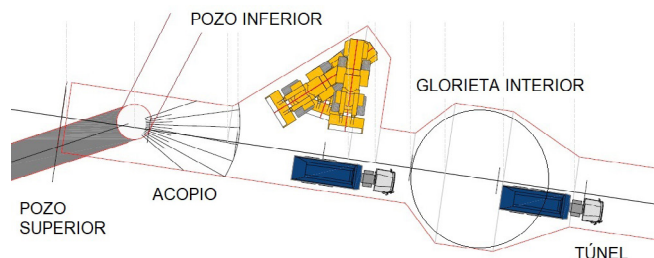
Planta de anchurón, culatón de túnel y glorieta interior
